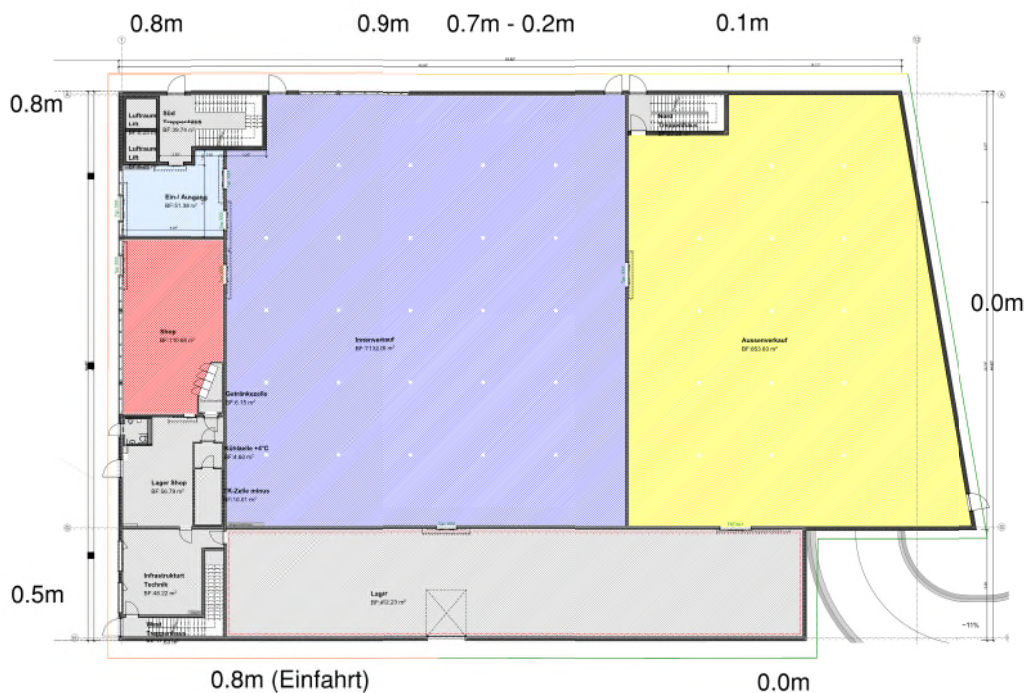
Grundriss Erdgeschoss mit Einwirkhöhen an der Fassade, basierend auf heutigen Terrainverhältnissen.
